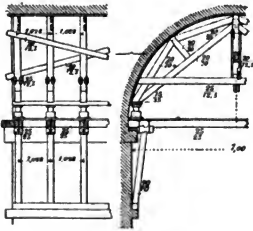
u. 131. Lehrgerüst mit Sprengwerken. M. 1 : 150.
